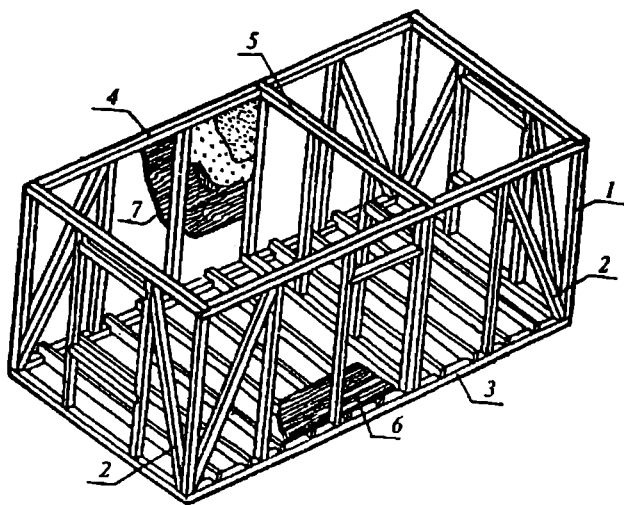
А. Вариант коробки каркасного корпуса бани (сауны):
